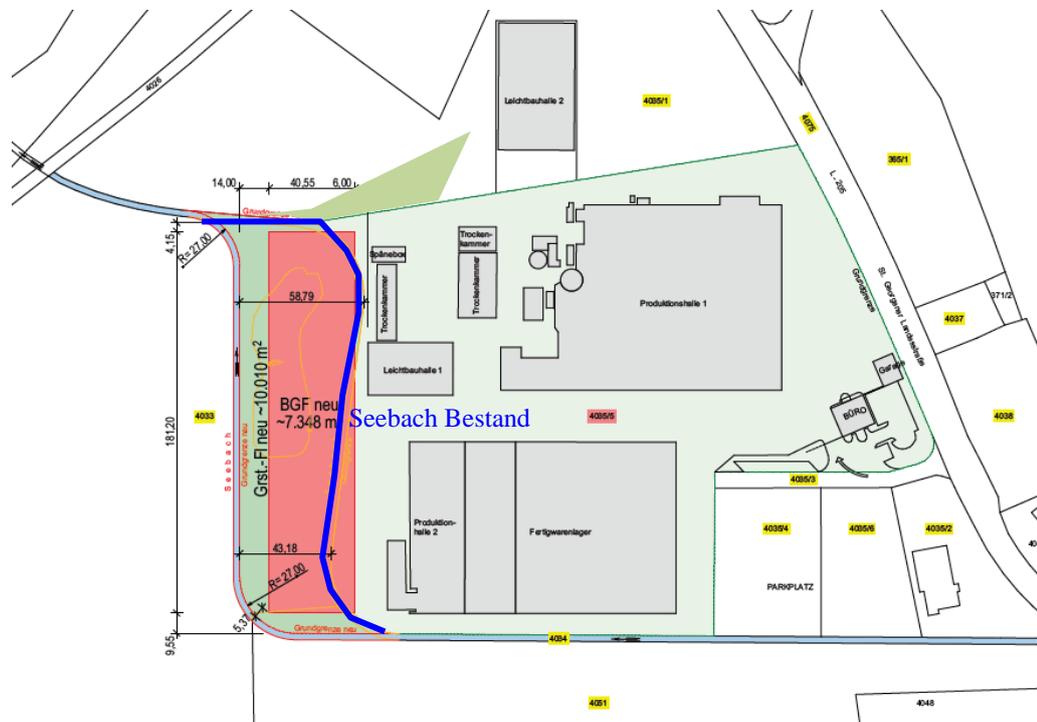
Lageplan Huber-Meixner & Partner (Quelle: Entwurf Lageplan Grst. Erweiterung, Stand 27.03.2019, [6])
